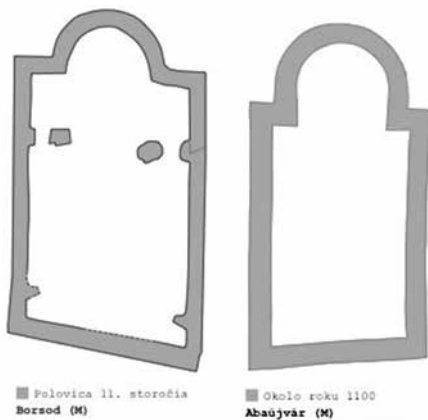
Grundriss der Überreste der Kirche in Borsod. Foto Archiv des Verfassers.
